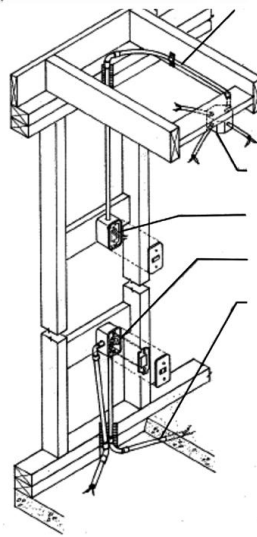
Detalle Fijación tubería eléctrica a elementos de madera.
